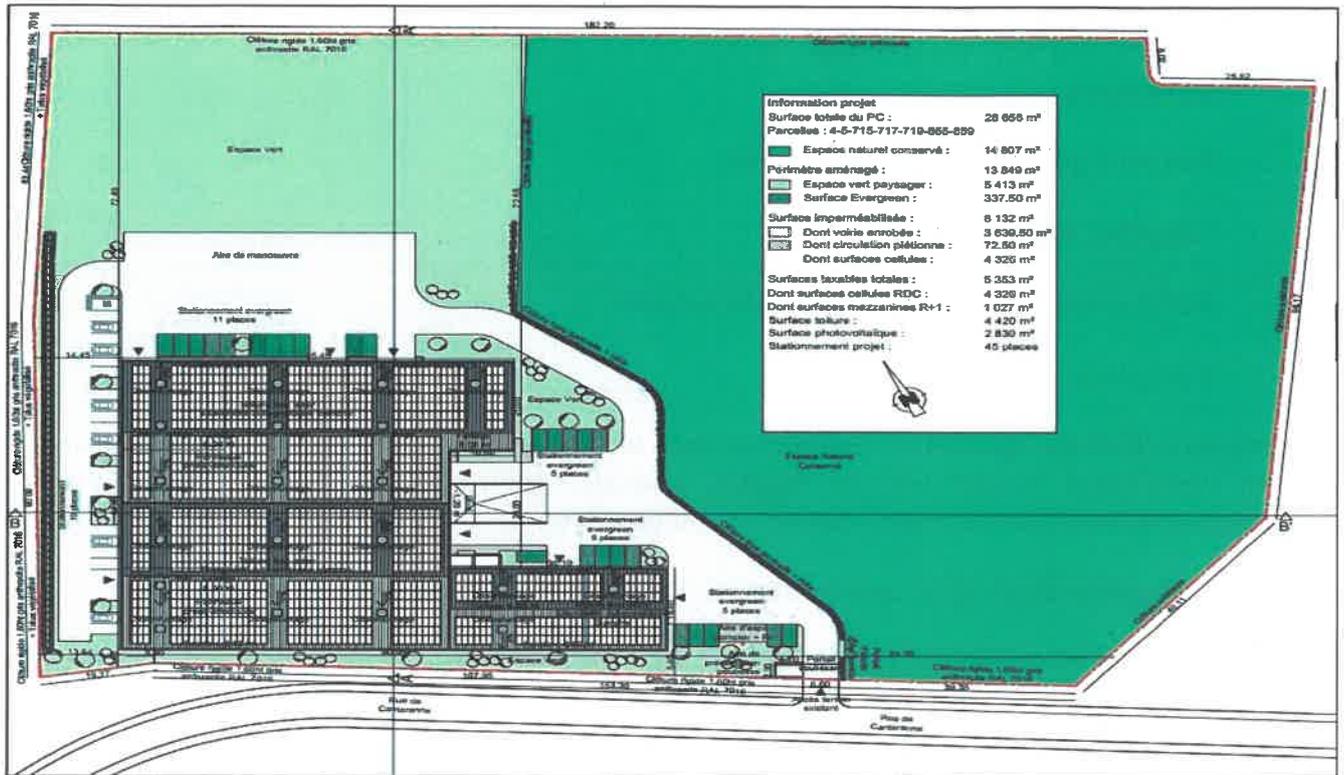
Plan de masse du projet de construction d'un bâtiment d'activités
